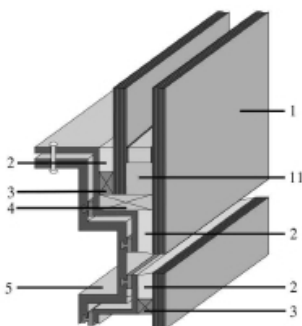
A: Detail dwarsverbinding. Voorbeelden van structurele beglazingsontwerpen: 4-zijdig ontwerp (in de fabriek beglaasd).
